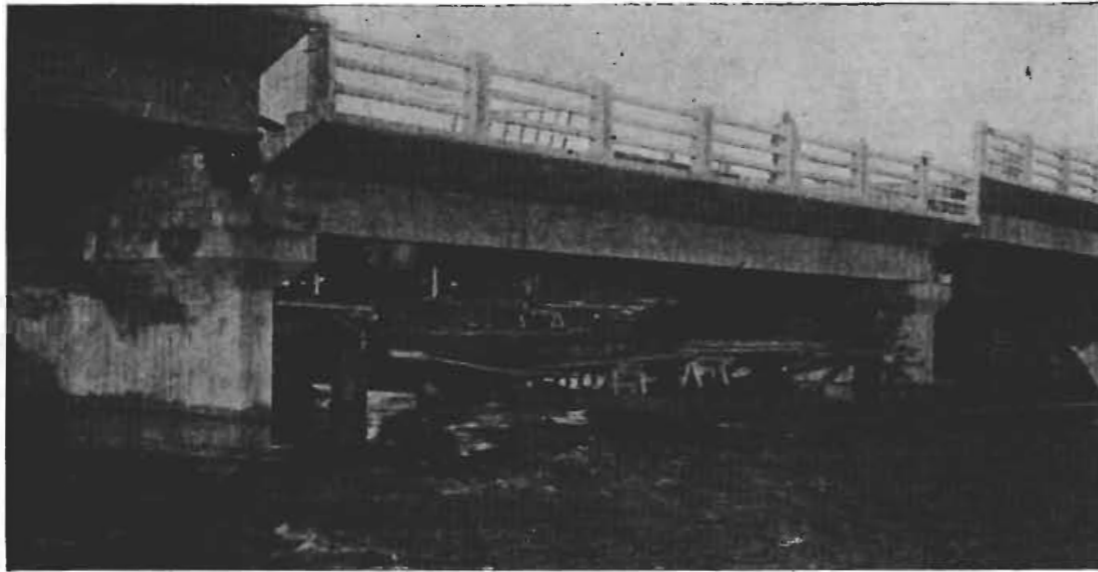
Ejecución de las obras de elevación de la superestructura en el puente sobre el arroyo Tapalqué, camino de acceso a Tapalqué.
